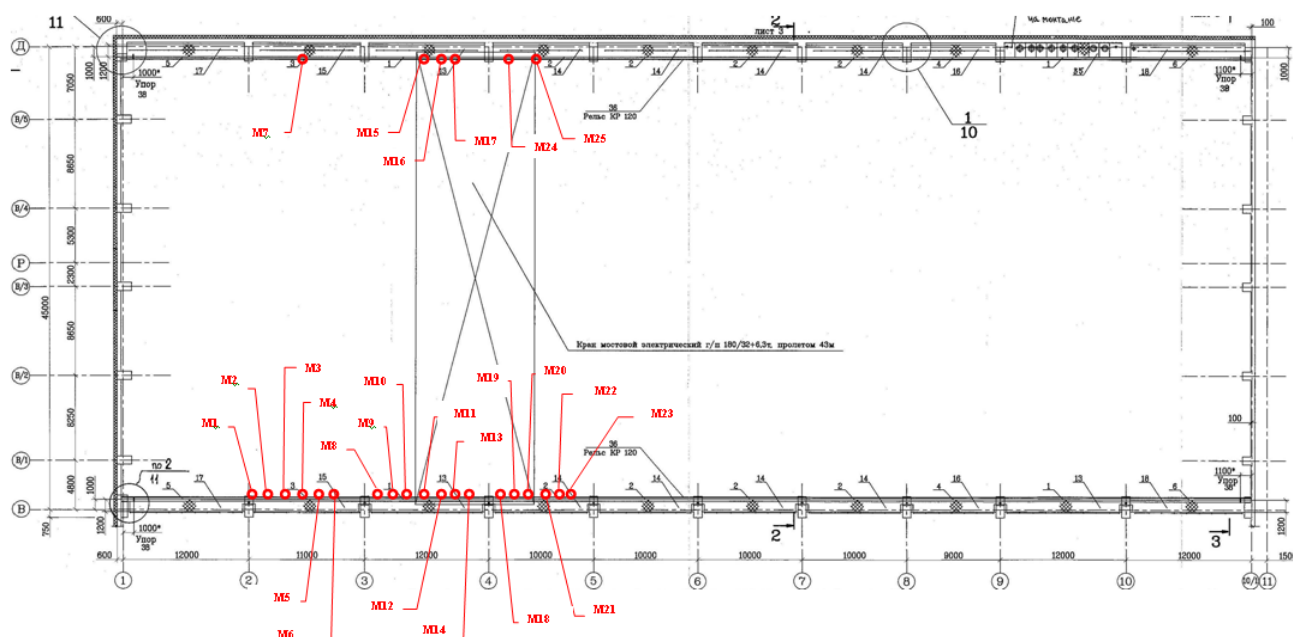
Схема расположения отражателей на нижних поясах подкрановых балок
